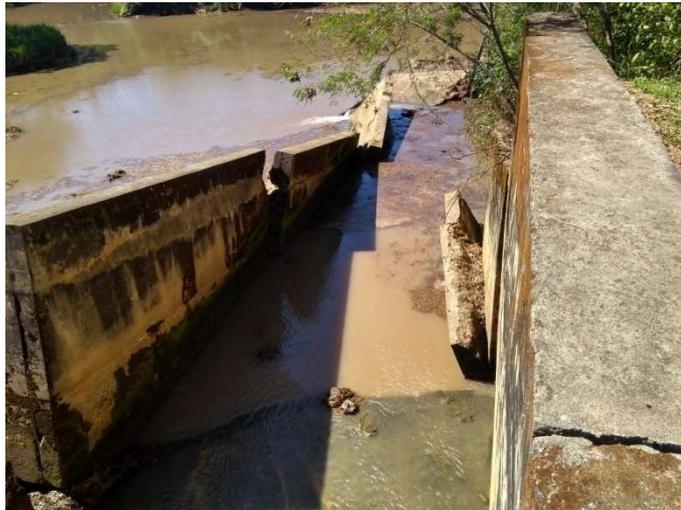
Canal de Restituição Margem Direita, Colapsada
